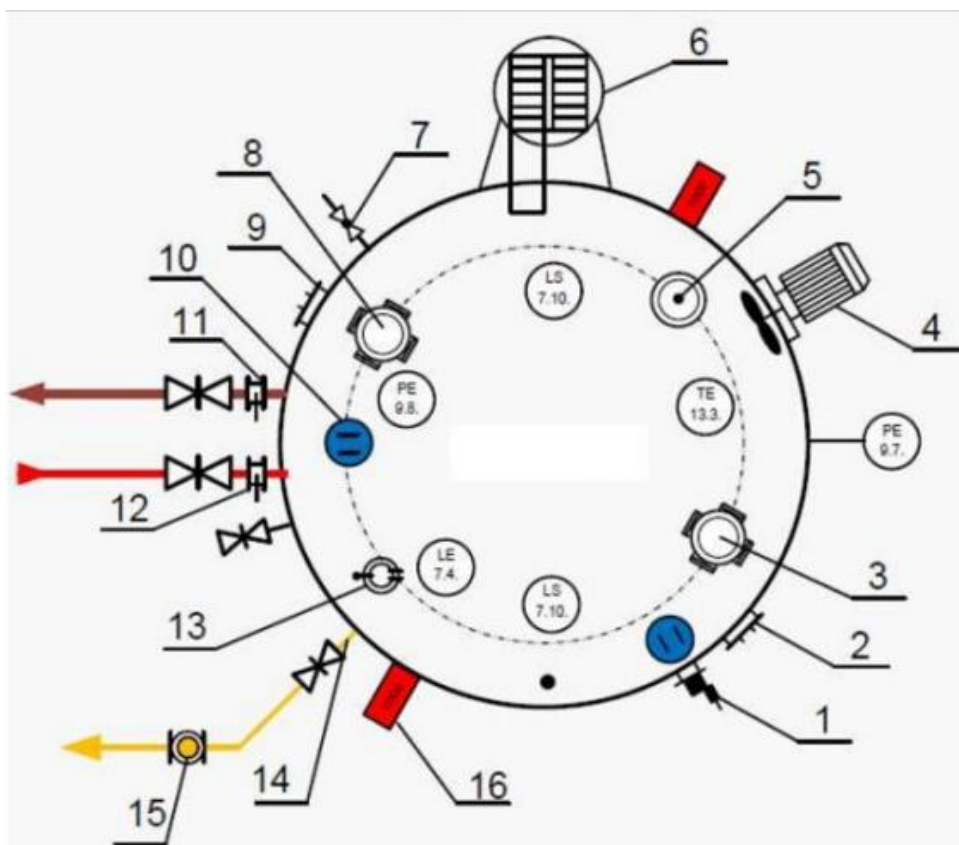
Схема расположения оборудования на резервуаре «вид сверху»
